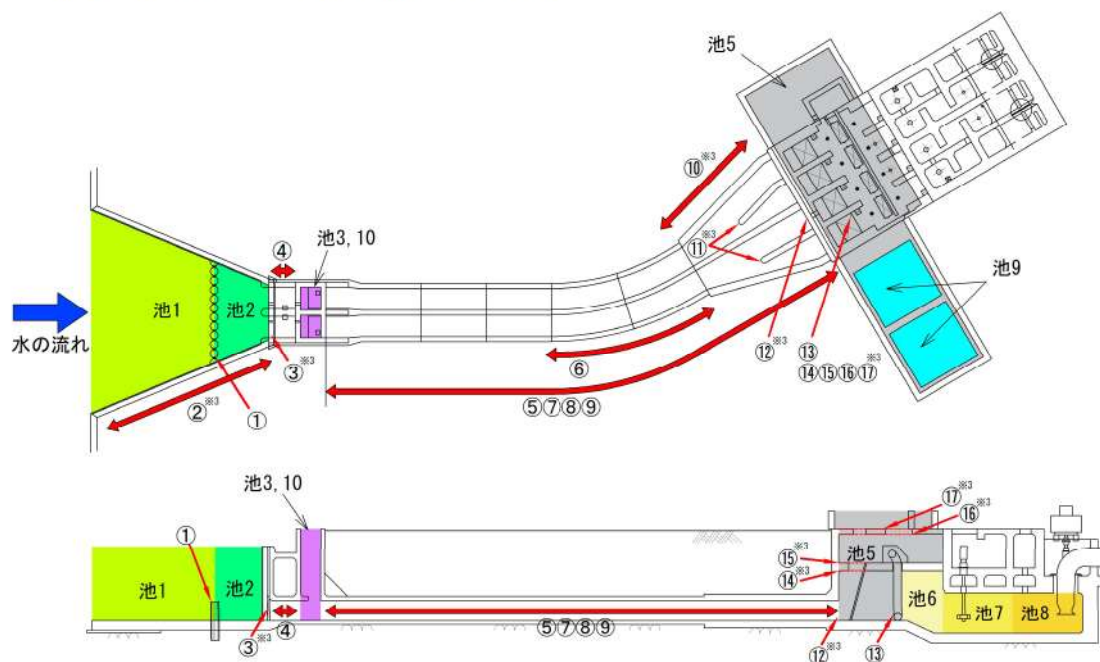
3号炉取水施設の損失水頭発生位置（上図：平面図，下図：断面図）
